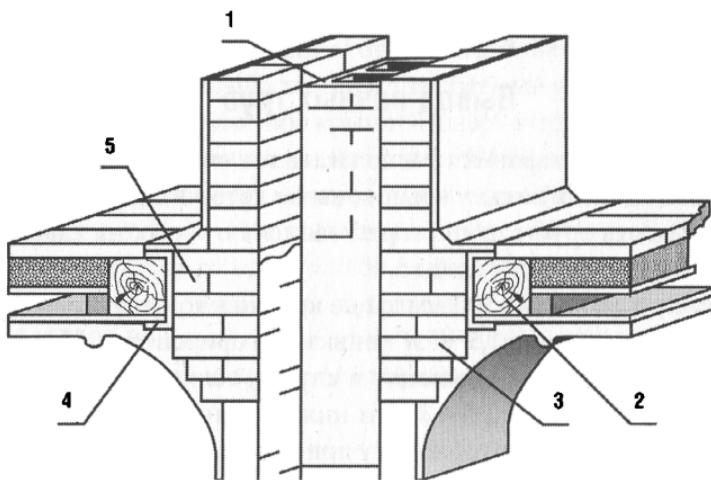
Разделка дымохода в междуэтажном деревянном перекрытии:
